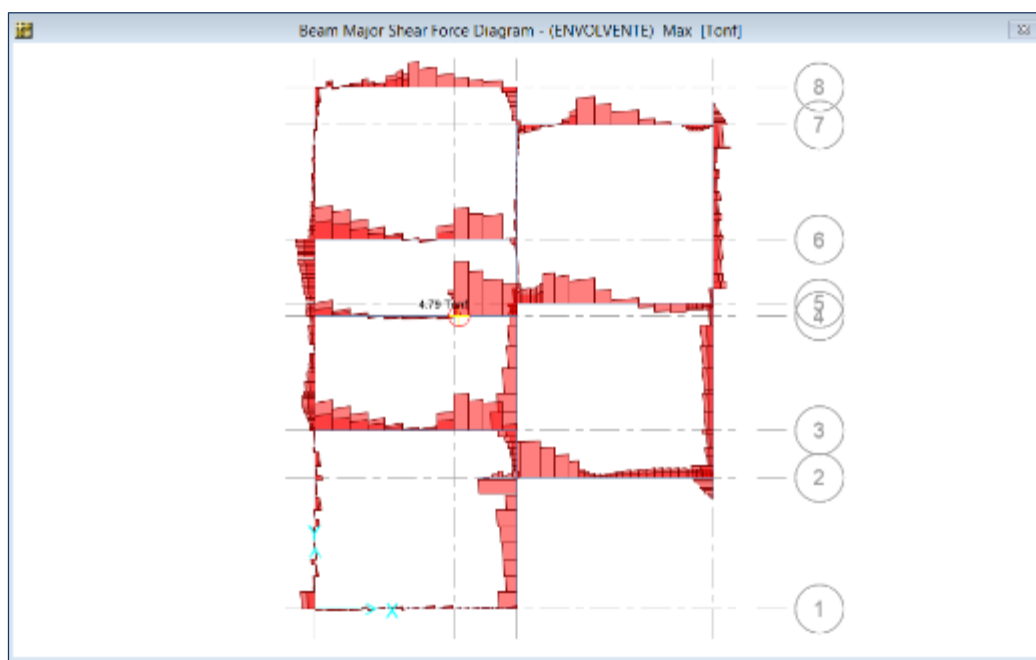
Fuerza Cortante máximo en la viga de cimentación.
